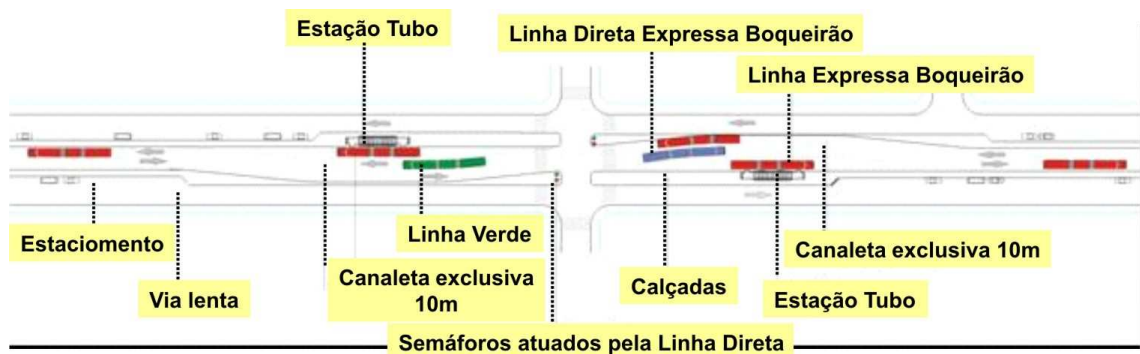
Esquema de ultrapassagem canaleta eixo Boqueirão - situação proposta
